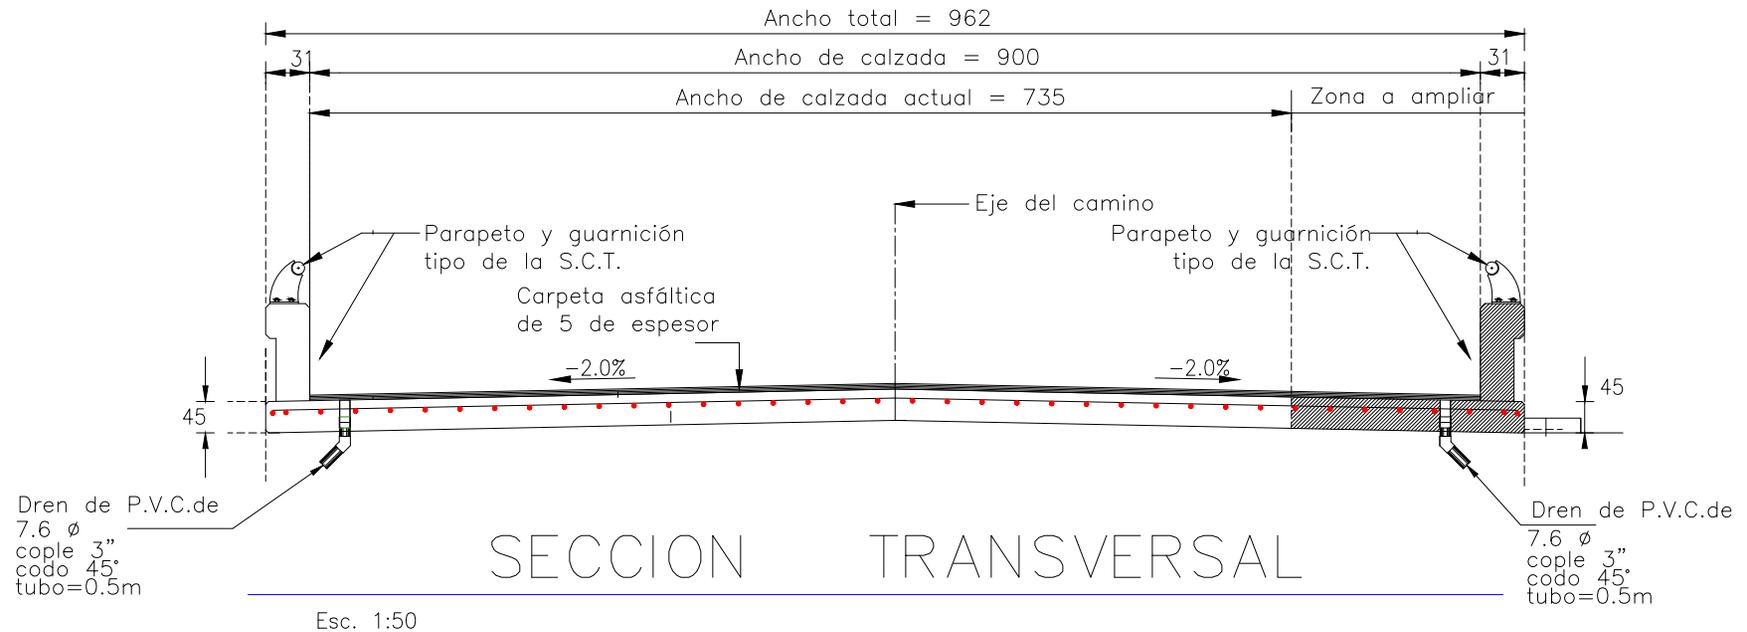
Sección estructural tipo en puente Chantón, Km 81+013.15
